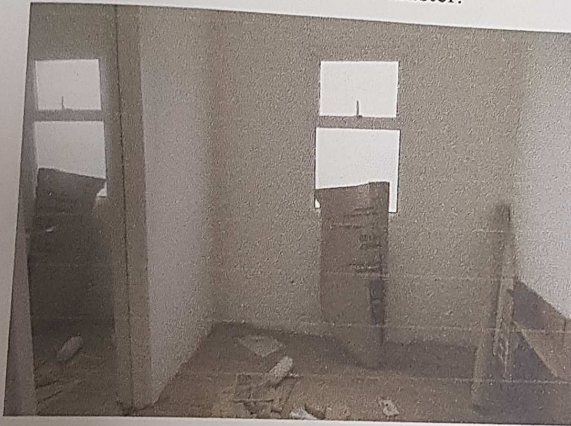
Vista parcial da passagem do closet para o banheiro da suíte master.
